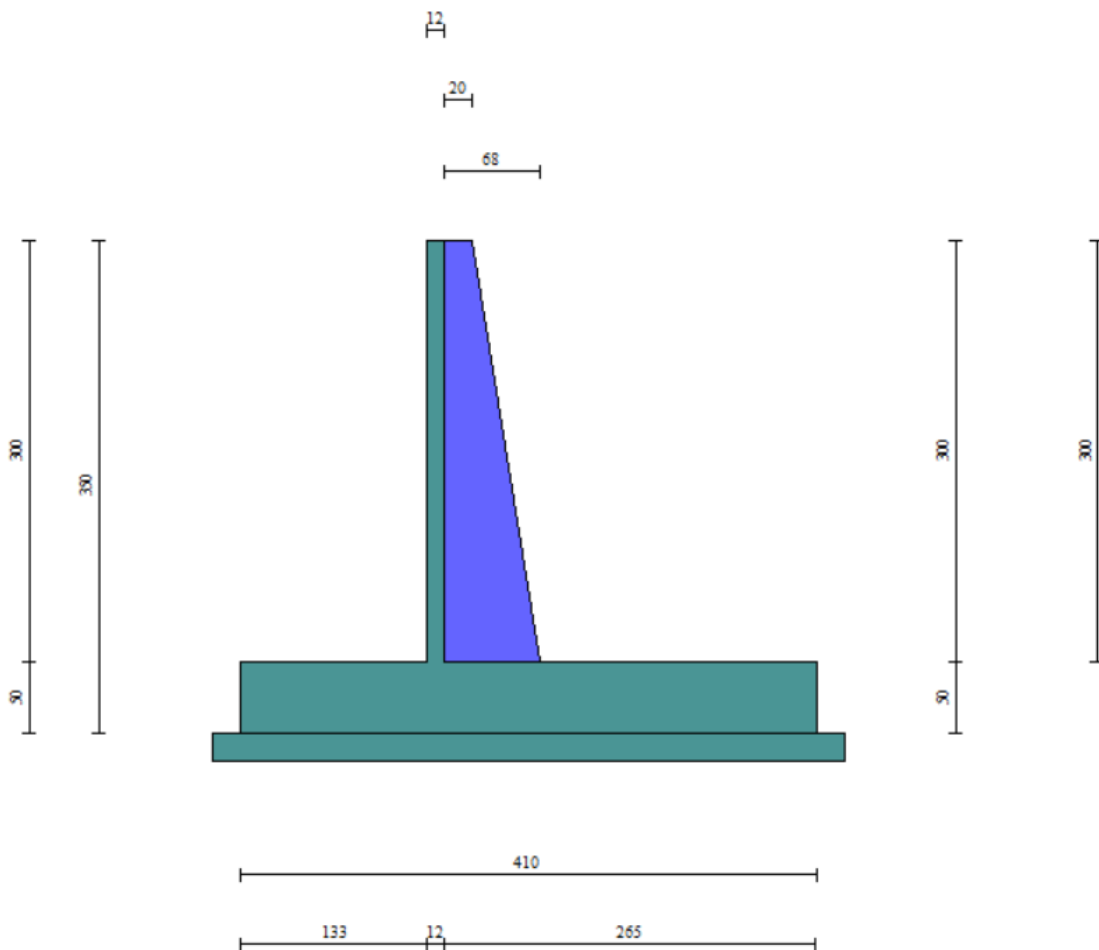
Geometria dei MURI DI SOTTOSCARPA - FONDAZIONE DIRETTA - TIPO 3
